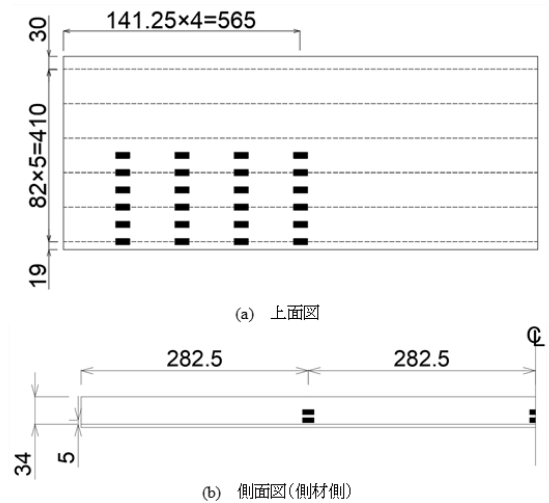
ひずみゲージ位置 (typeF, 単位: mm)
